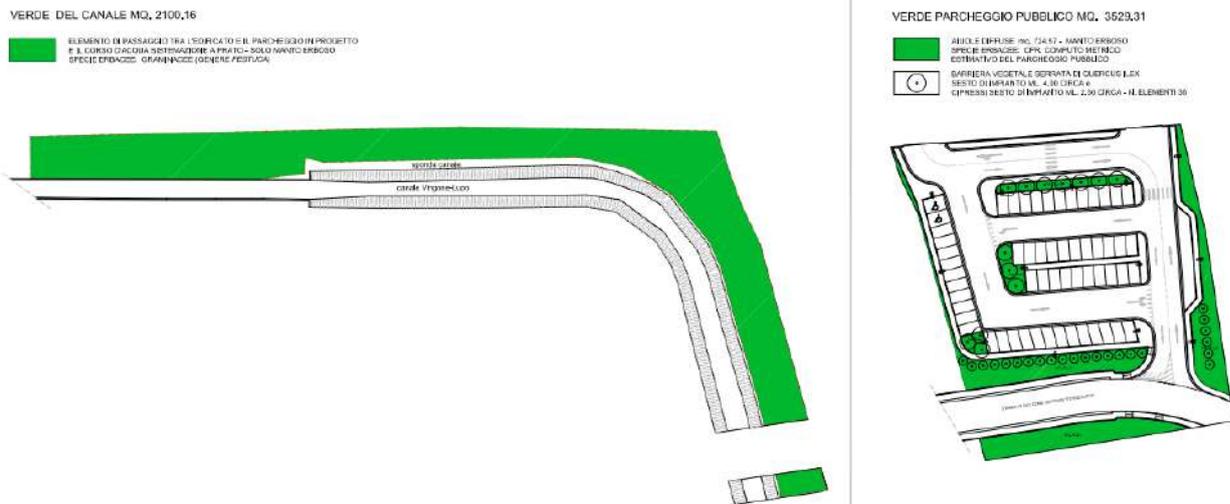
Progetto planivolumetrico - Schema generale del Progetto del verde Tav. E10 (Fonte: Piano Attuativo PMU 4.4)
